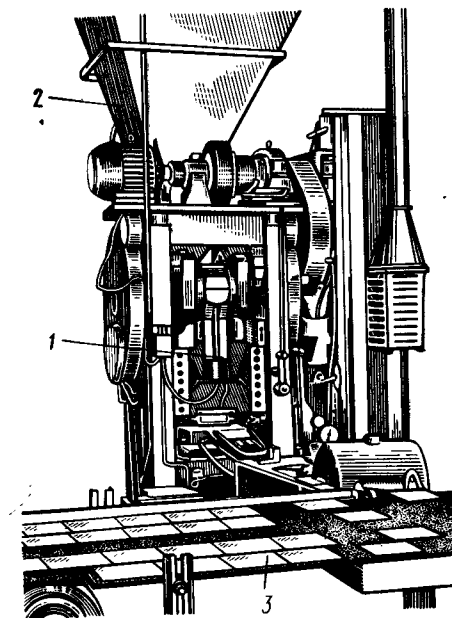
Пресс-автомат полусухого прессования: 1 — механический пресс; 2 — бункер пресс-порошка; 3 — конвейер
